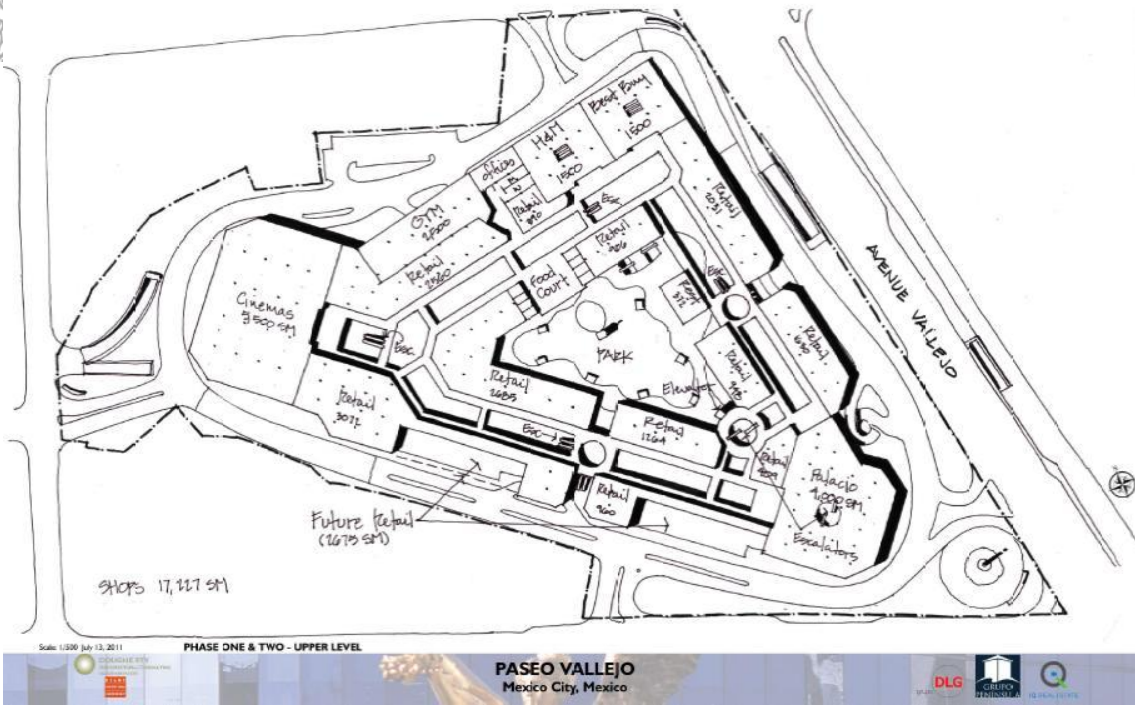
SEMBRADO DE LAS ESTRUCTURAS DE INTERES
